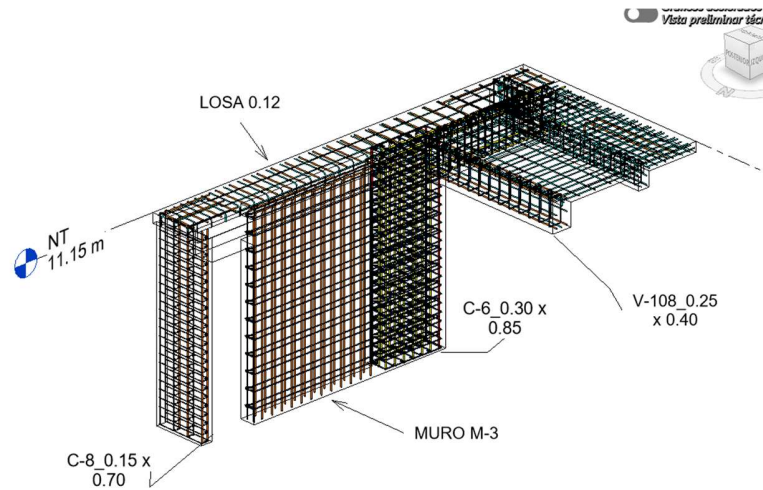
Anclaje de muro a un marco viga columna y losa
